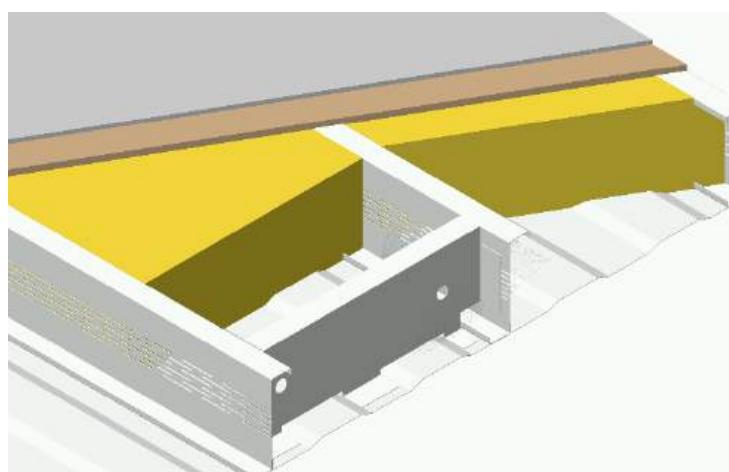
Cassette légère en acier avec âmes perforées [31]
